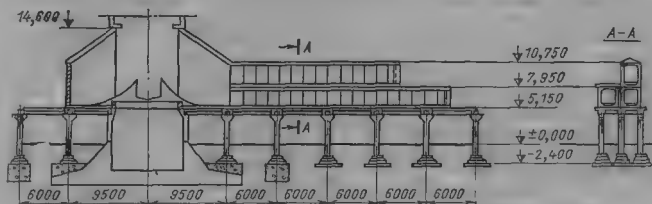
Борова к дымовой трубе из сборных железобетонных конструкций
